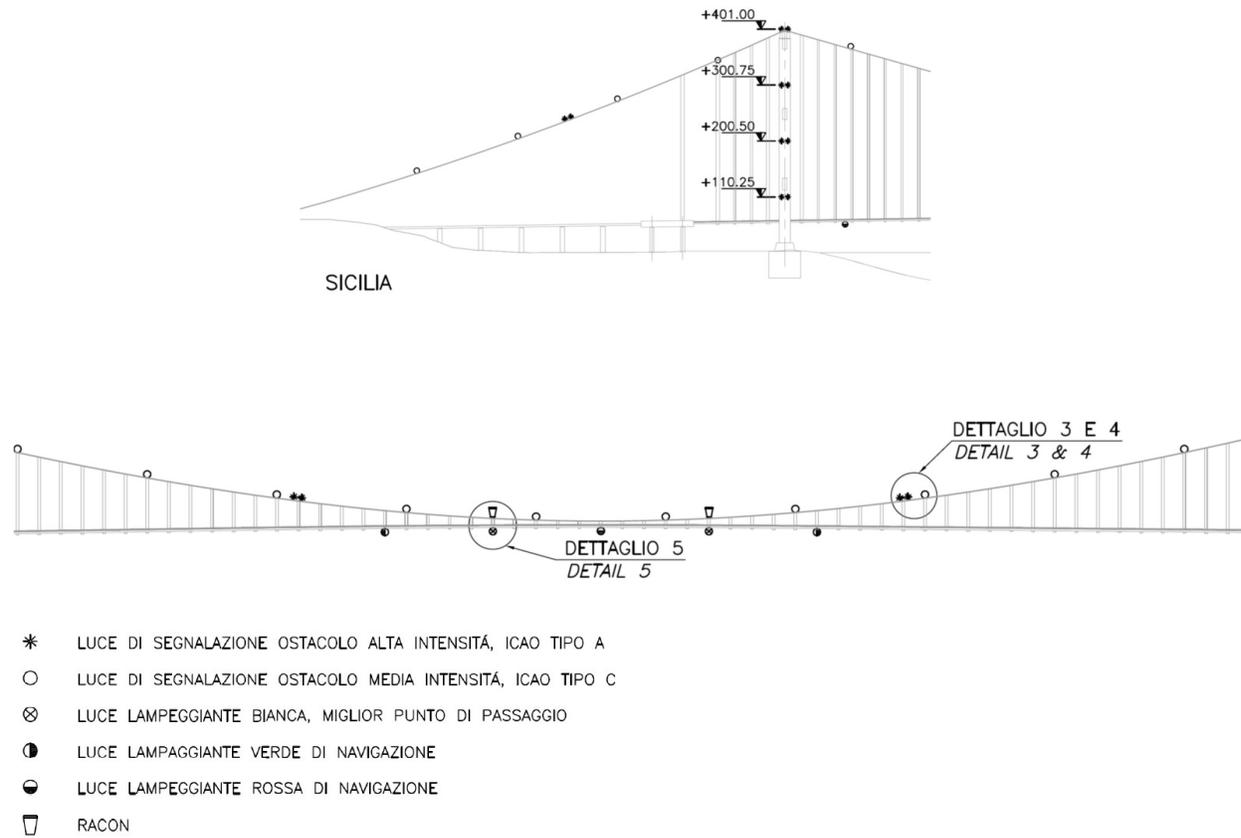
Stralci tratti dalla tavola di progetto: Planimetria di progetto –Impianti tecnologici illuminamento marittimo ed aereo (PI0087_F0)
